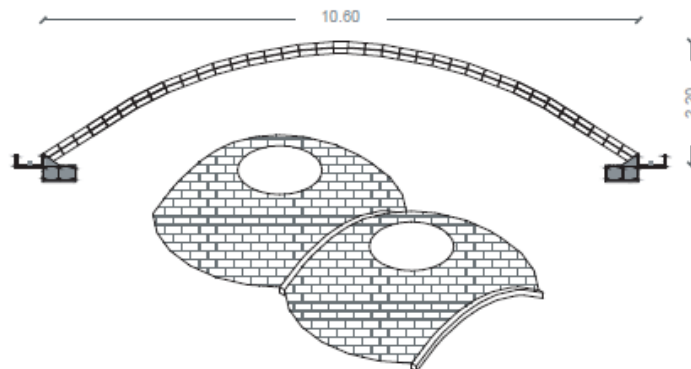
Detalle constructivo cubierta, ventana en lucernario
